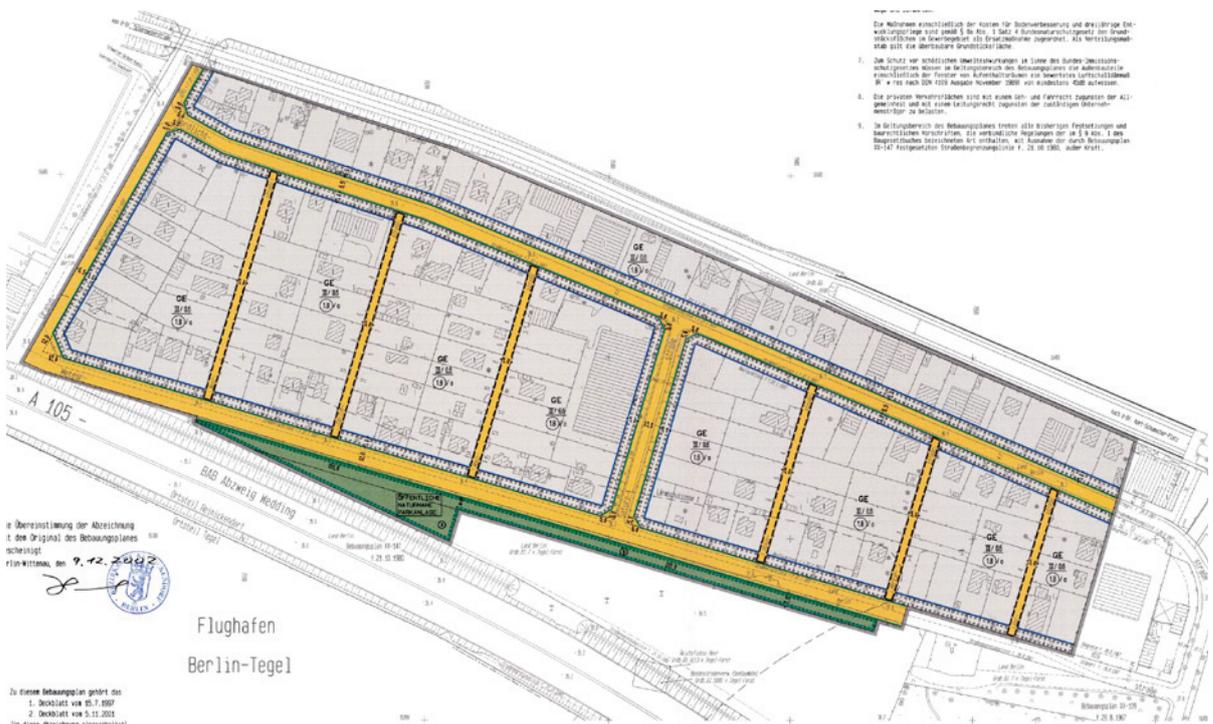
Bebauungsplan III-242, Bau- und Heimwerkermarkt Kurt-Schumacher-Damm (Auszug), Quelle: Tegel Projekt GmbH
